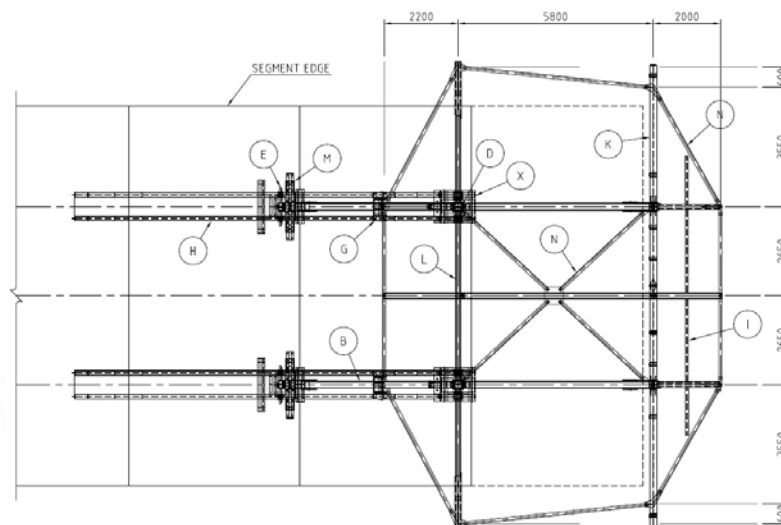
Vista en planta, Carro de Avance. (Fuente: NRS – Puente Chilina GRA)
